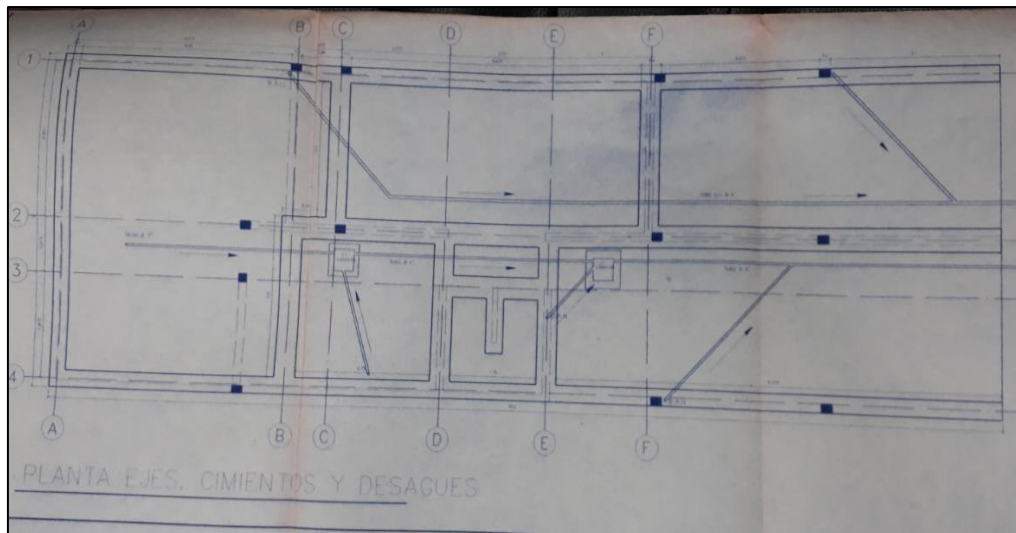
Planta cimentación, vivienda unifamiliar. Fuente propia
